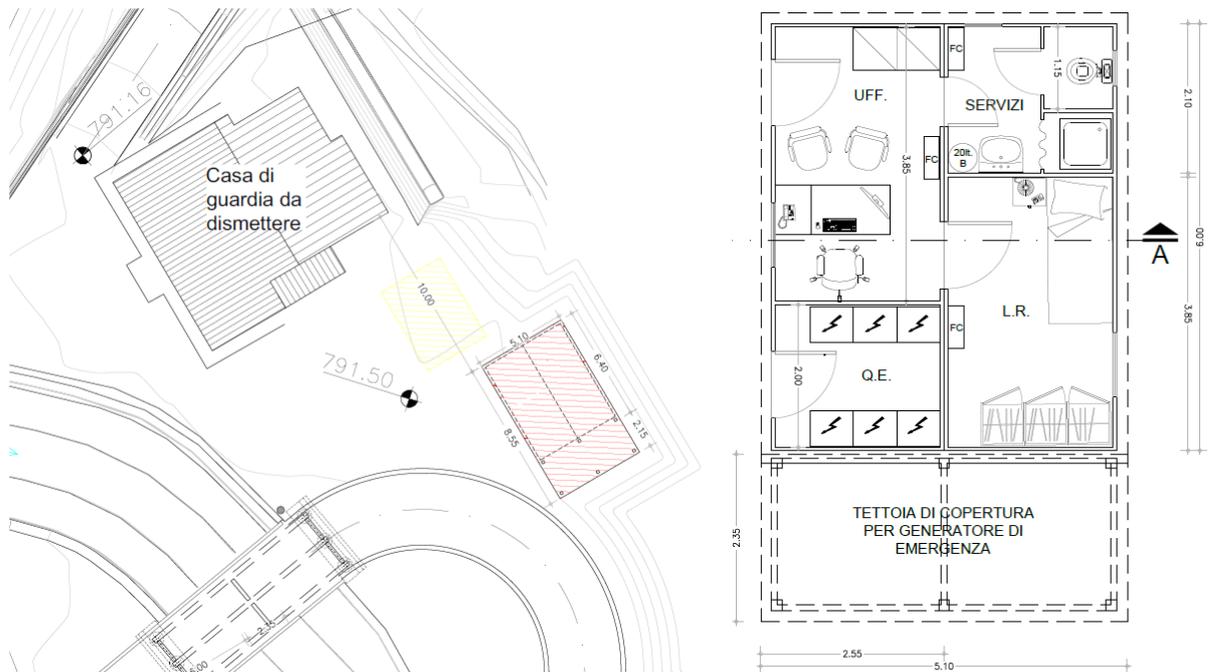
nuovi locali per la guardiania: planimetria e pianta.
